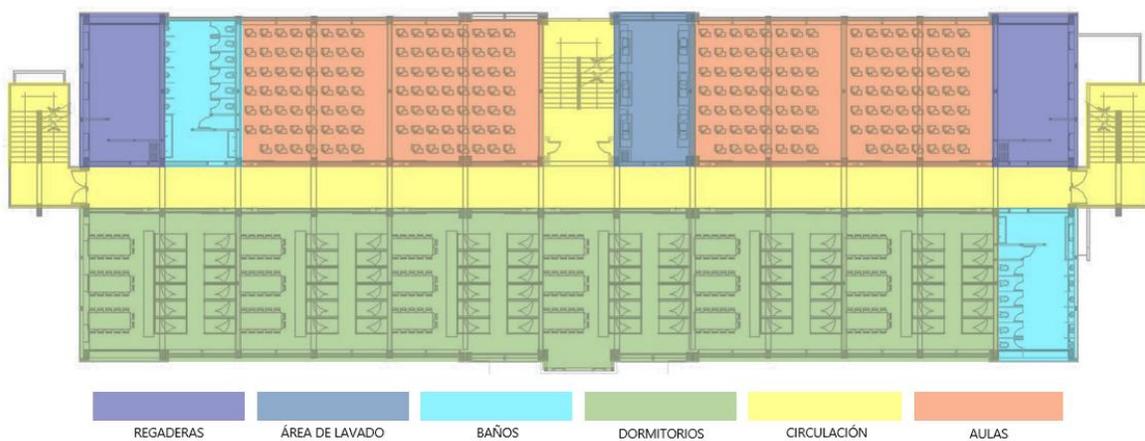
Planta Tipo Edificio Principal Villa de los Niños
